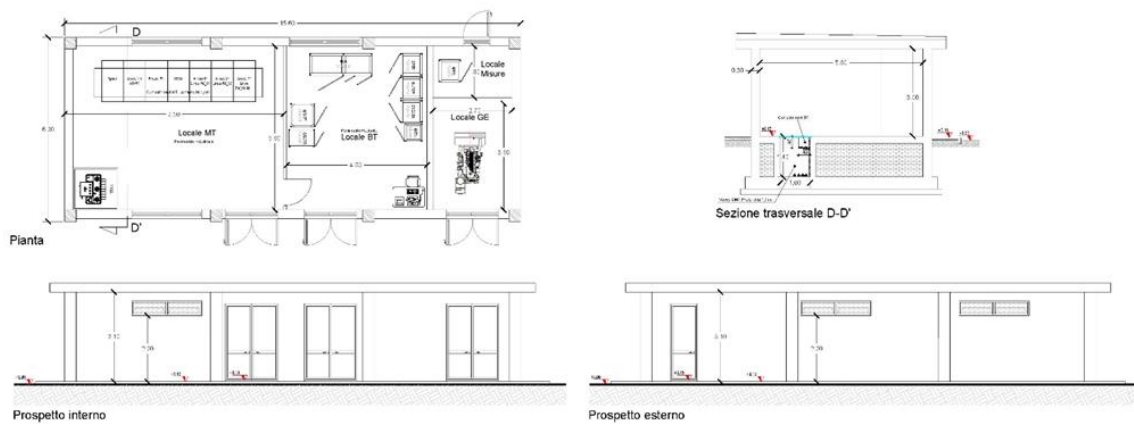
Locali tecnici stallo di elevazione AT/MT
